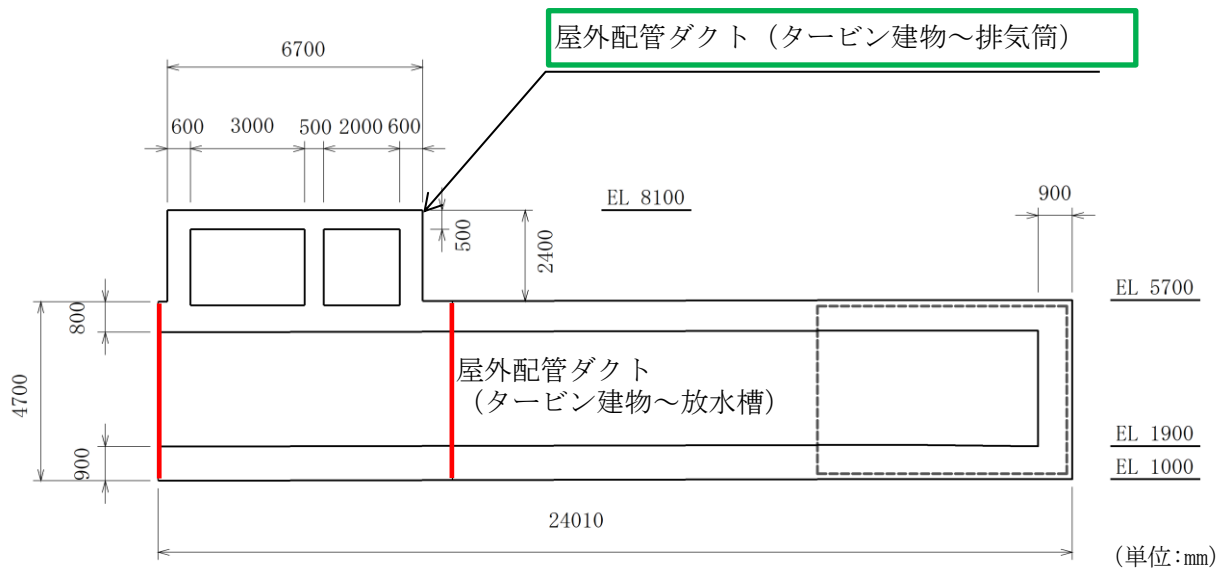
屋外配管ダクト (タービン建物～排気筒) 断面図 (B-B断面)
